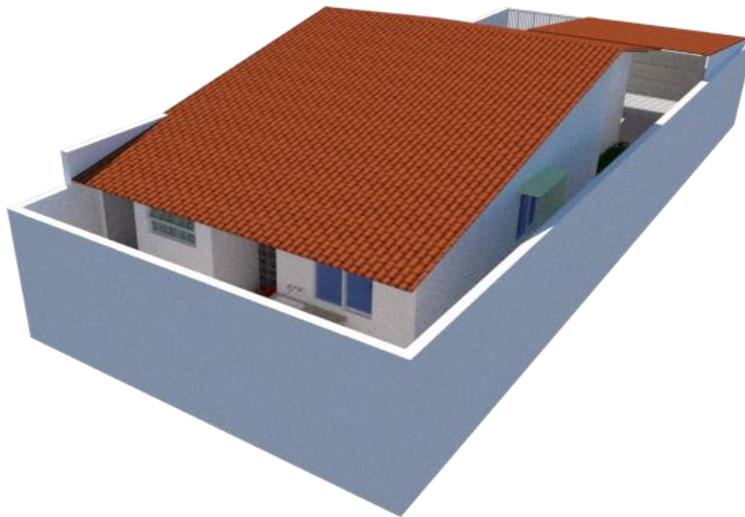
Proposta orientada à Noroeste - Fachada lateral
